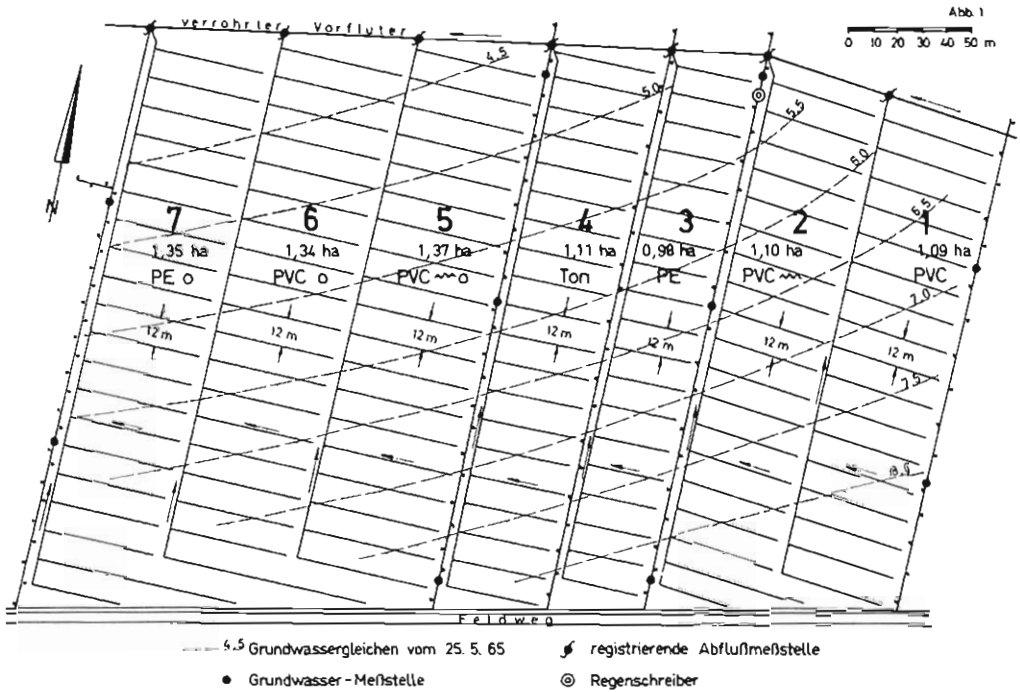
Versuchsanlage Norderheistedt, Lageplan mit Grundwassergleichen vom 25. Mai 1965
